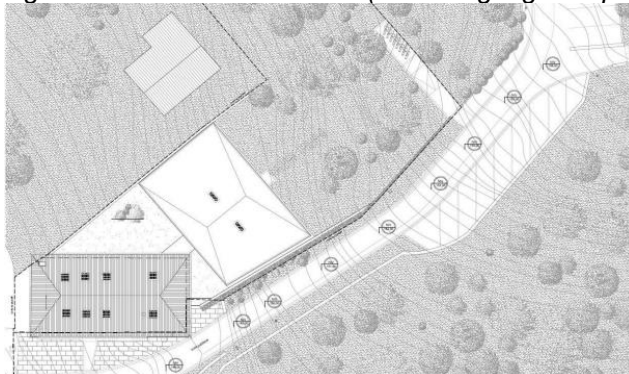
Plan masse du projet (source : ADT - Atelier Delalande Tabourin)
